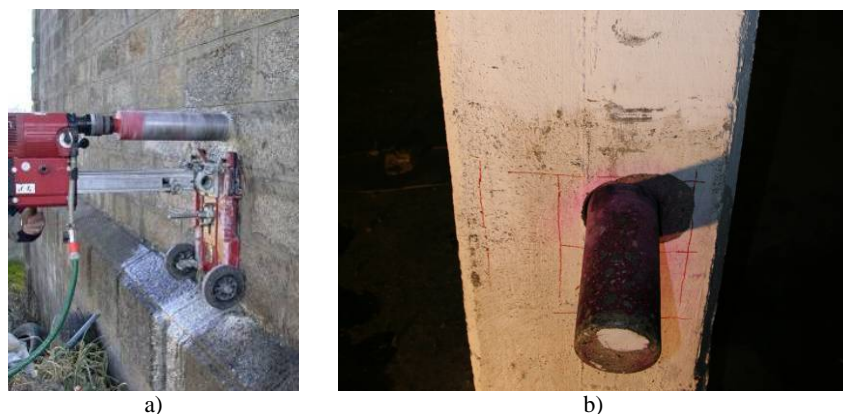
Extracção de carotes em: a) granito b) betão armado com a marcação do posicionamento das armaduras
